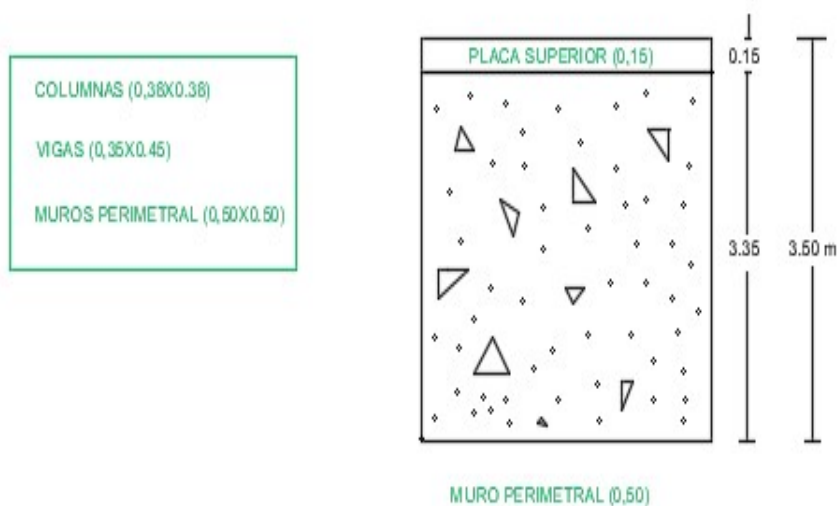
Plano corte transversal. Fuente: Elaboración propia Programa Autocad.
